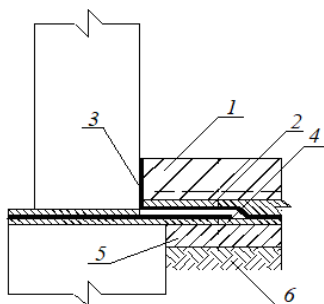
Сочетание фрагментированного барьера с поэтапно устраиваемой мембраной: 1 — монолитный, армированный дорожной сеткой бетон; 2 — защитный слой; 3 — рулонный гидроизоляционный материал; 4 — выравнивающая стяжка; 5 — подготовка из тощего бетона; 6 — уплотненный грунт
